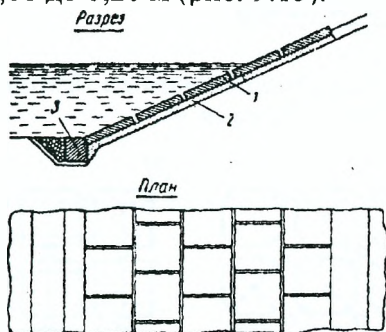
Укрепление откоса сборными бетонными плитами: 1 – бетонные плиты; 2 – щебеночная или гравийная подготовка; 3 – бетонный упор
